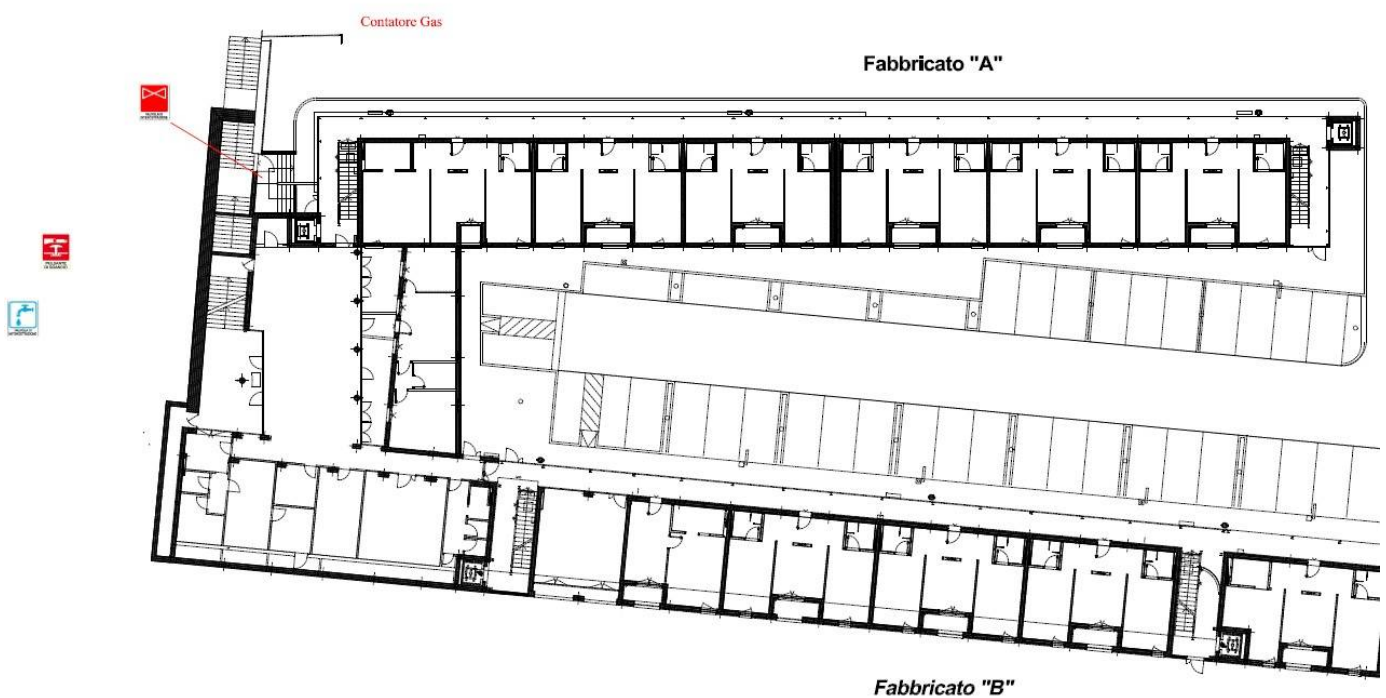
PLANIMETRIA CON PULSANTI SBLOCCO
